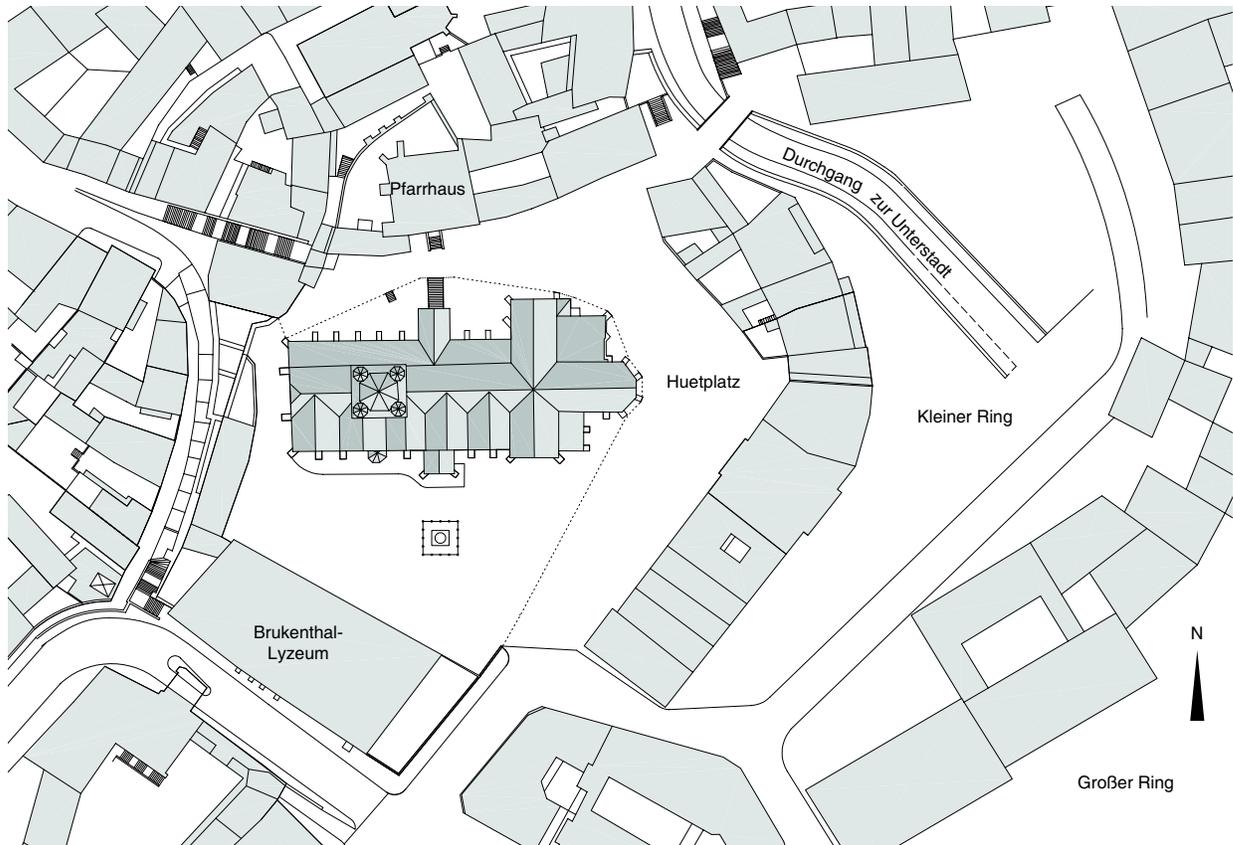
Lageplan (nach Unterlagen von Prof. Dr. Szabó / Fa. Utilitas)
